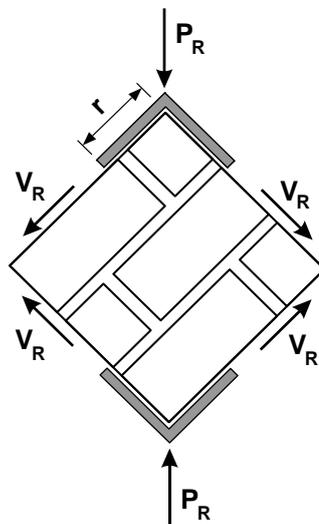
Esquema de ensayo a la compresión diagonal de muretes de mampostería.
